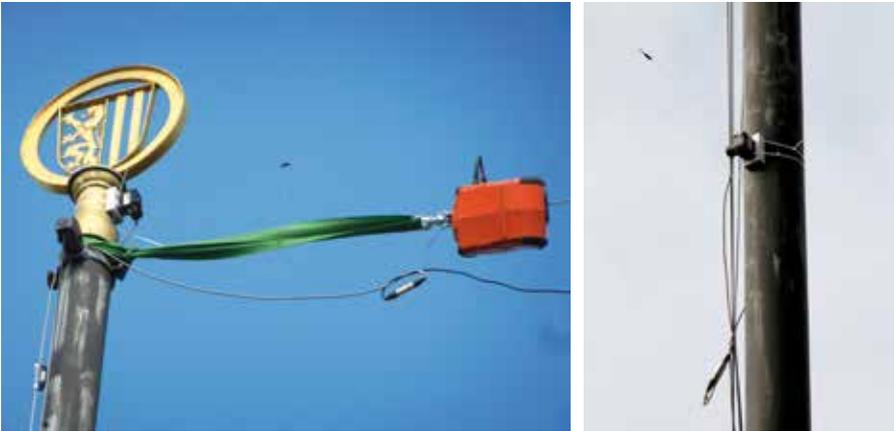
Details des Versuchsaufbaus; links: Befestigung der elektronischen Seilwinde mit der Kraftmessdose und oberer Seilzugaufnahme; rechts: Seilzugaufnahme im oberen Drittelpunkt der Fahnenmasten Foto links: Kathrin Dietz, rechts: Sabine Wellner
